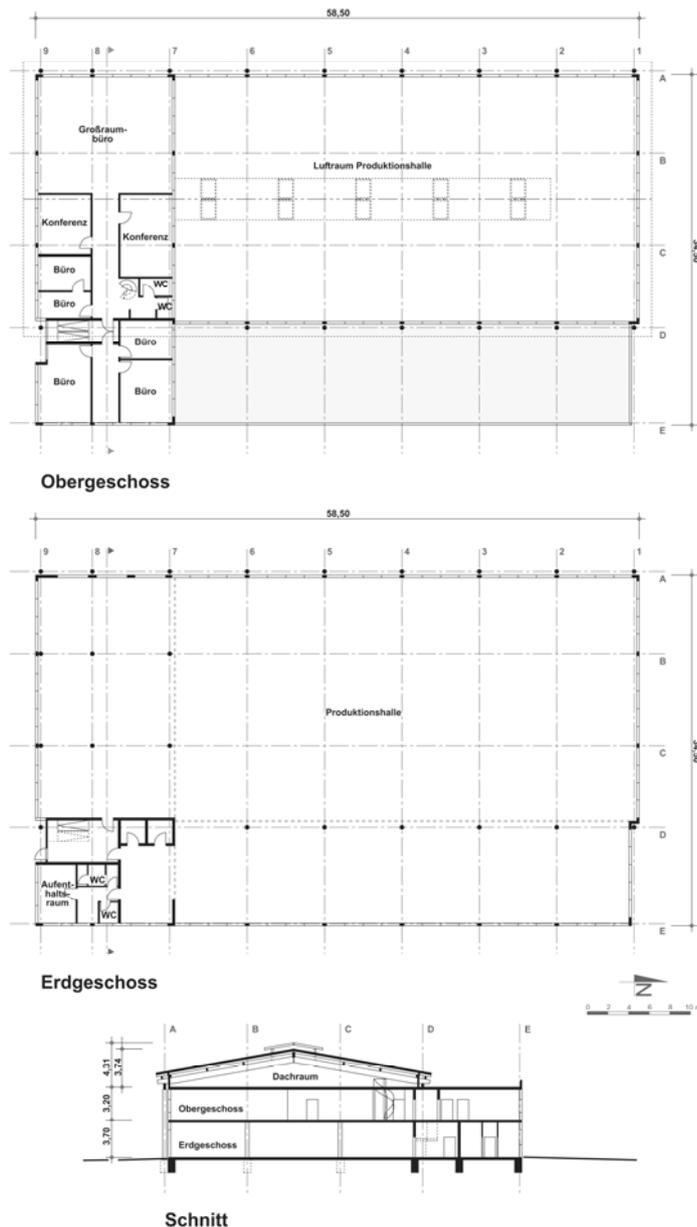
Grundrisse und Schnitt des untersuchten Büro- und Fertigungsgebäudes.
